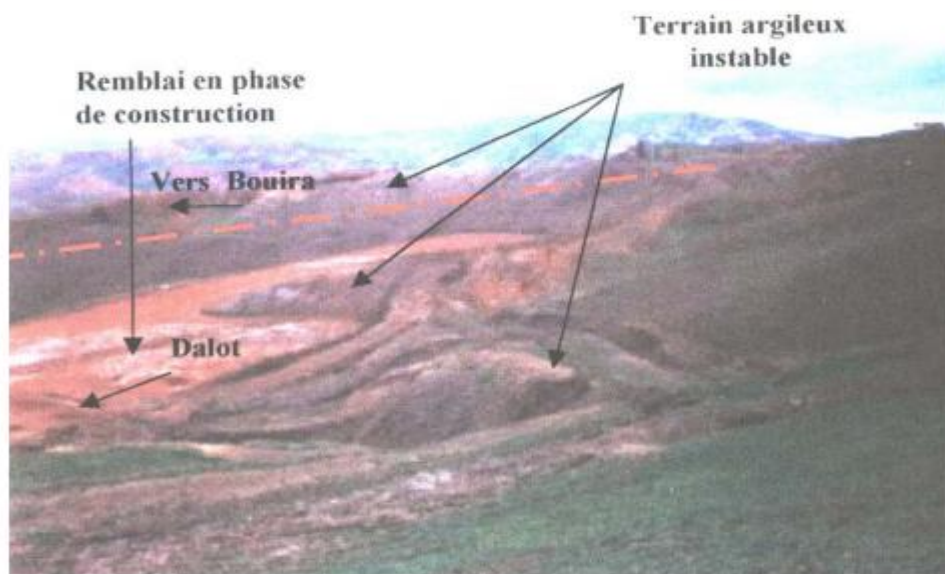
Remblai en cours de construction sur versant instable contournement de Bouira.
